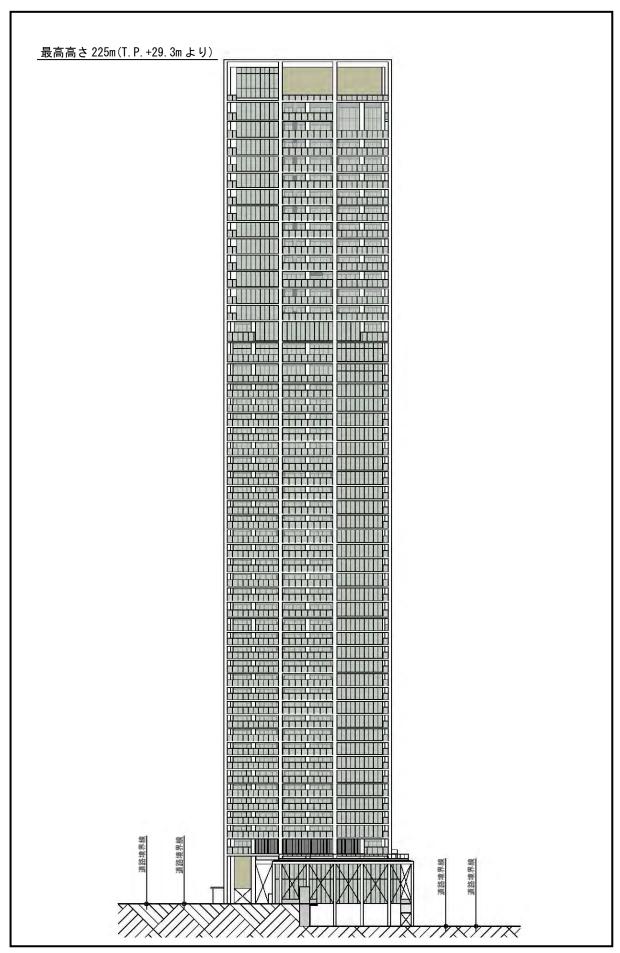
(6) 立面図 (南立面図 S=1:1,000) 【変更後】
